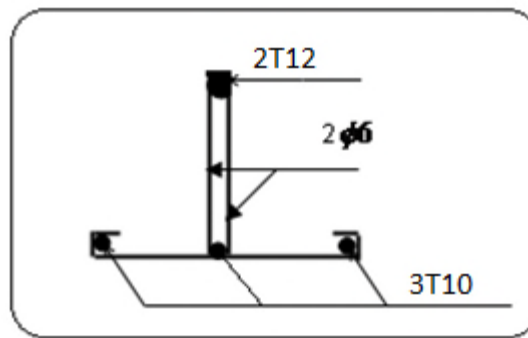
Schéma de ferrailage de la poutrelle type3.
